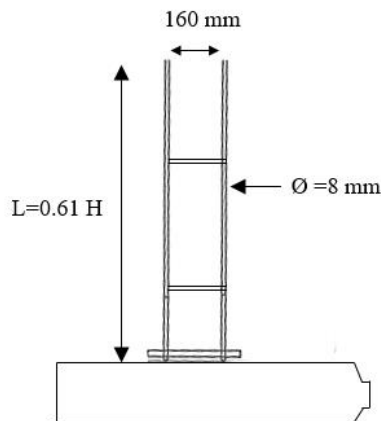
Detalle del refuerzo tipo malla de acero o escalera de acero.
